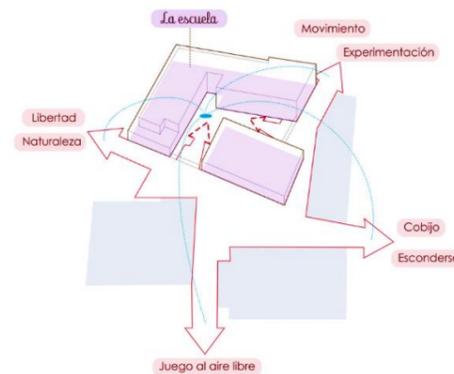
Plan Maestro. Fuente: Espacios Maestros
